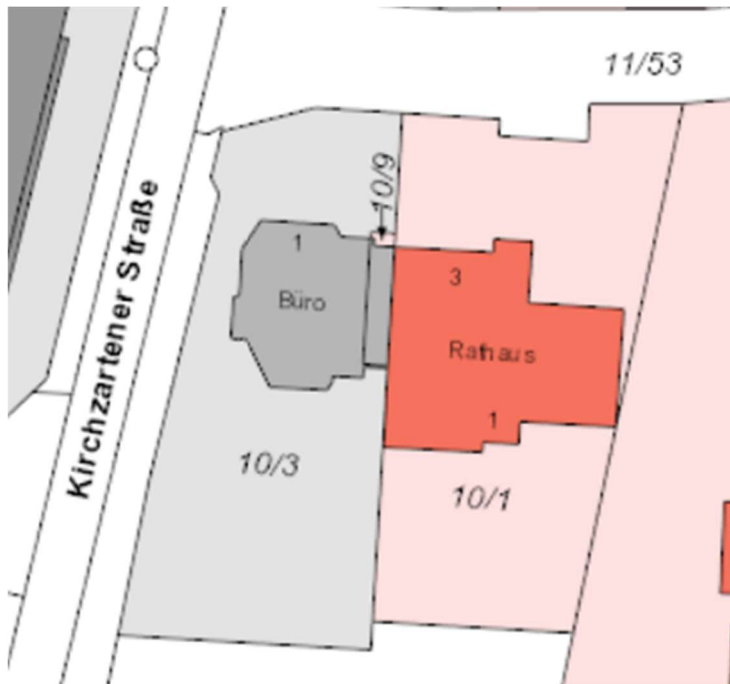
Lageplanausschnitt Rathaus/ Anbau
